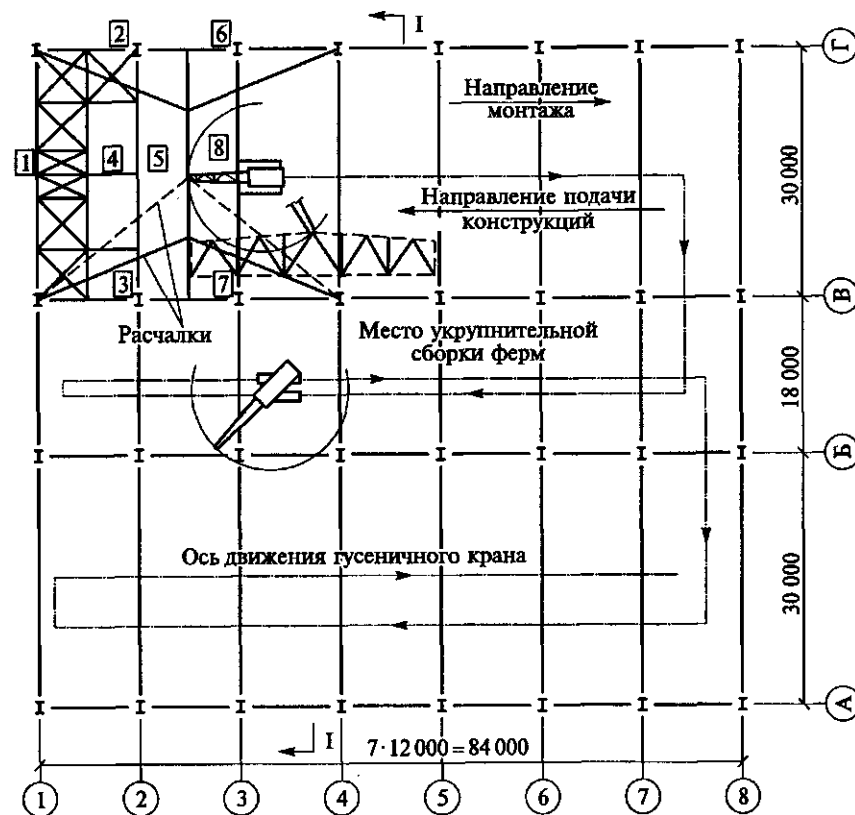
Рабочая схема монтажа промышленного здания:
